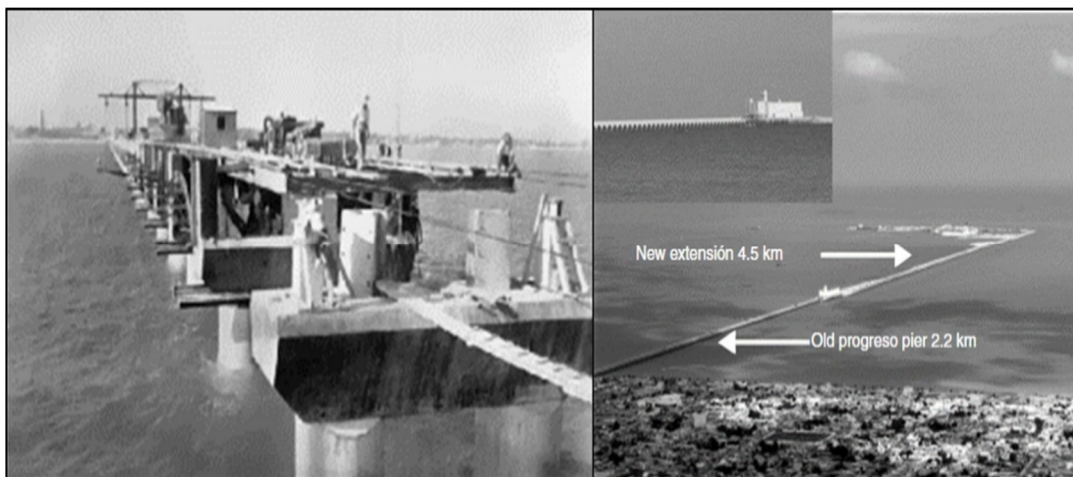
Puente Progreso en Yucatán (Mérida, Méjico): a la izquierda vista de pilas y vigas transversales durante el proceso de construcción y a la derecha fotografía aérea del antiguo muelle y la ampliación construida en los años 80 © [26]
